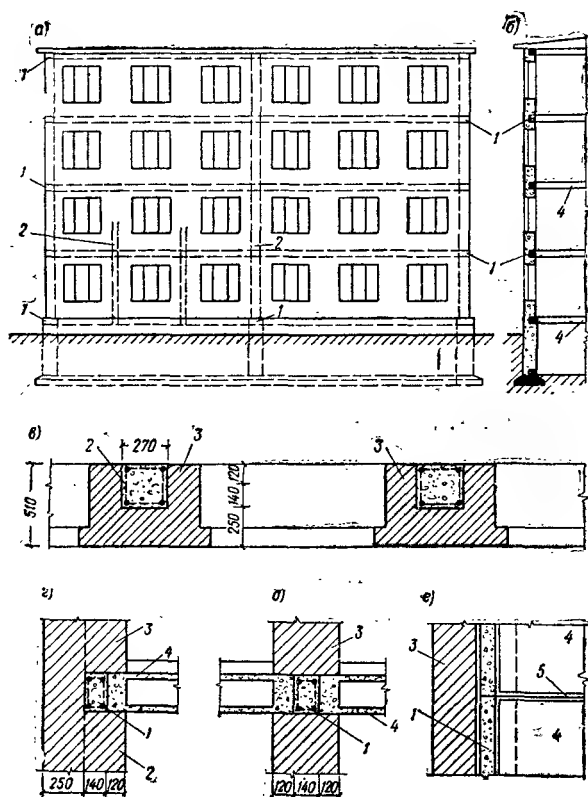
Расположение сейсмических поясов в зданиях с каменными стенами
